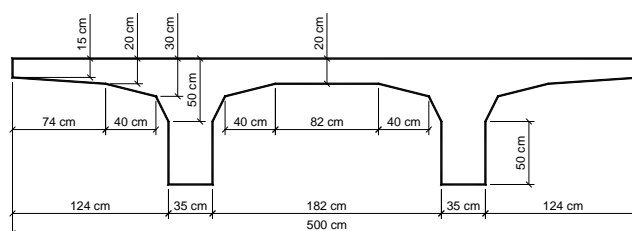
Sección transversal Puente de Casanova y Puente de Cuzcurrita
